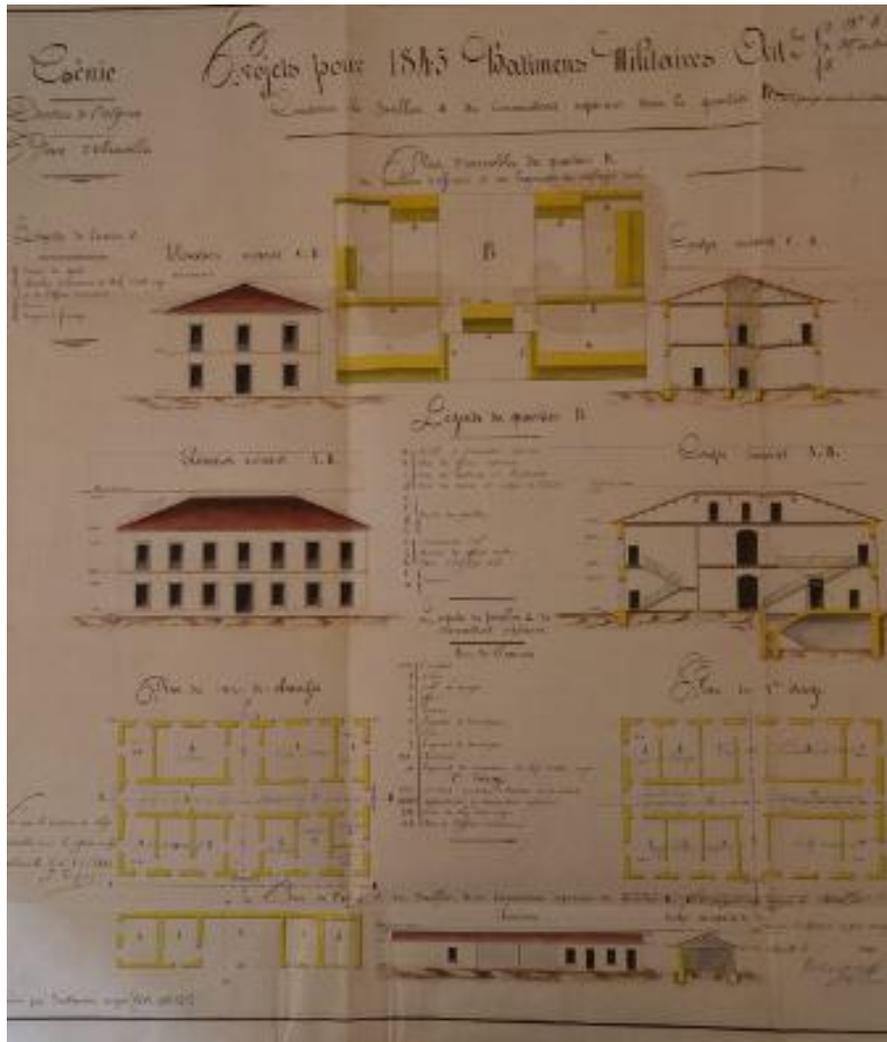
Plan D'un Batiment Militaire En 1845
